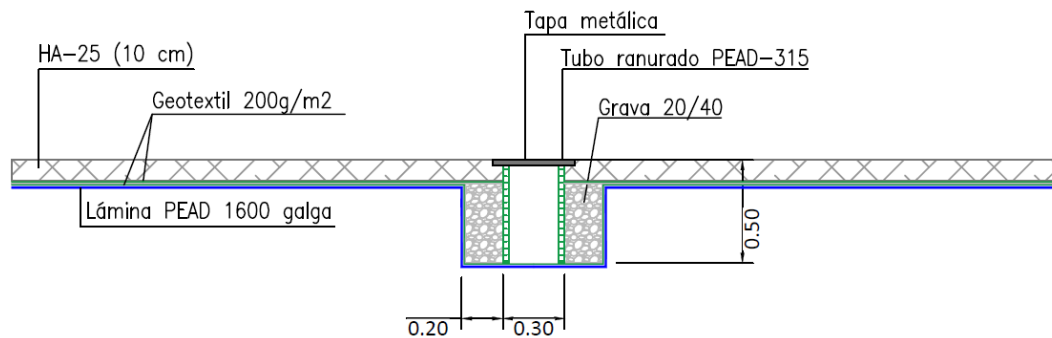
Detalle constructivo pozos de control PC-2 y PC-3
